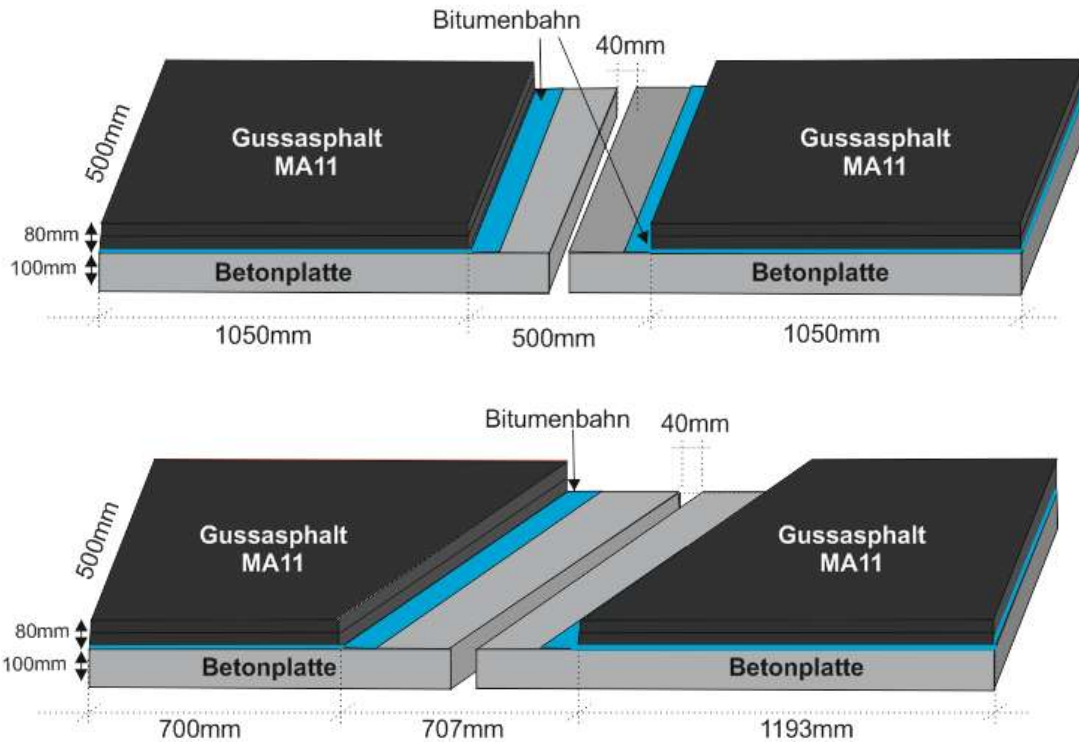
Aufbau der Prüfkörper-Betonelemente für den Prüfkörper 100 gon (oben) und 50 gon schiefwinklig zur Bauwerksachse (unten).
